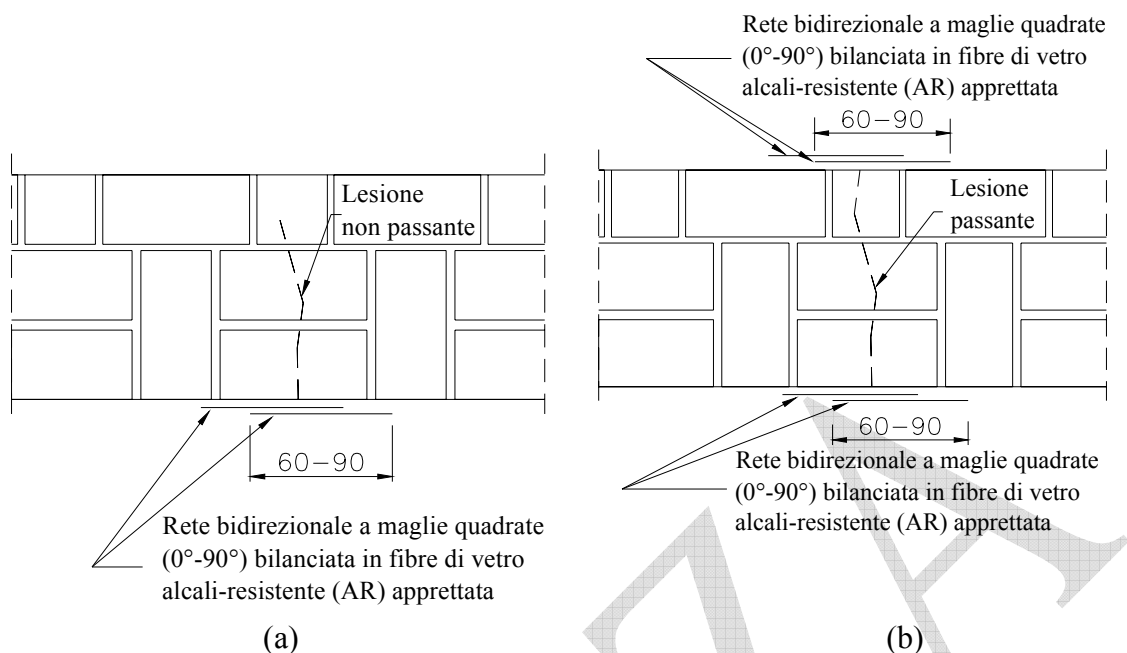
Applicazione di rete di rinforzo: vista in sezione trasversale nel caso di a) lesione non passante; b) lesione passante
